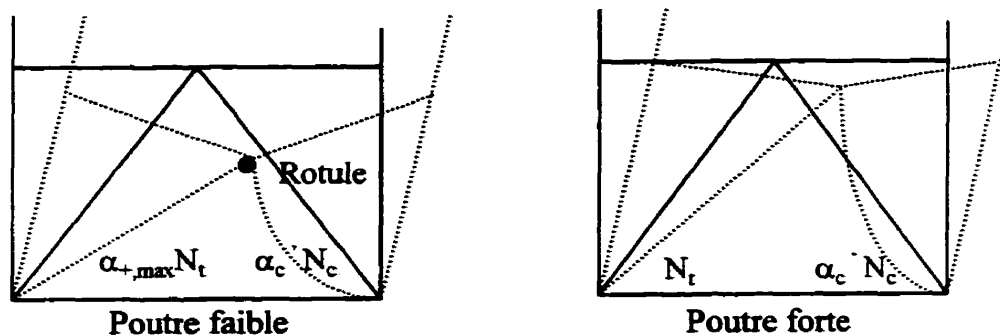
Comparaison entre une poutre faible et une poutre forte
